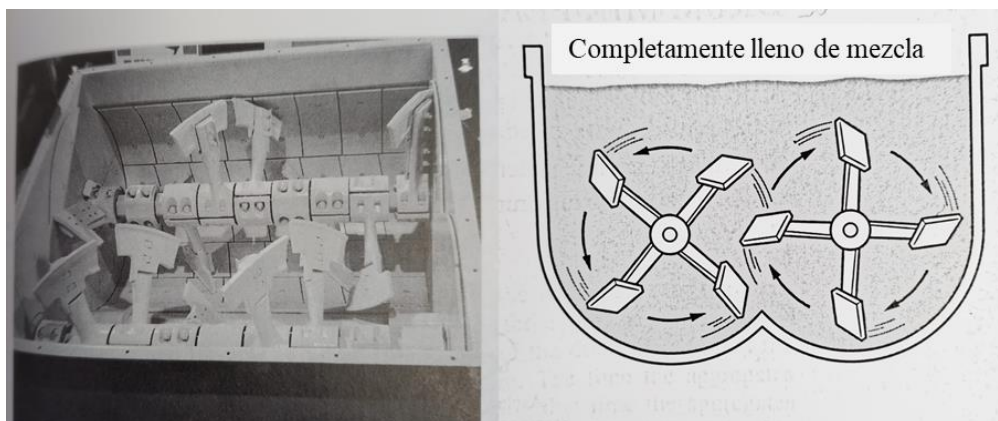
Caja de doble eje para mezclar el concreto asfáltico.
